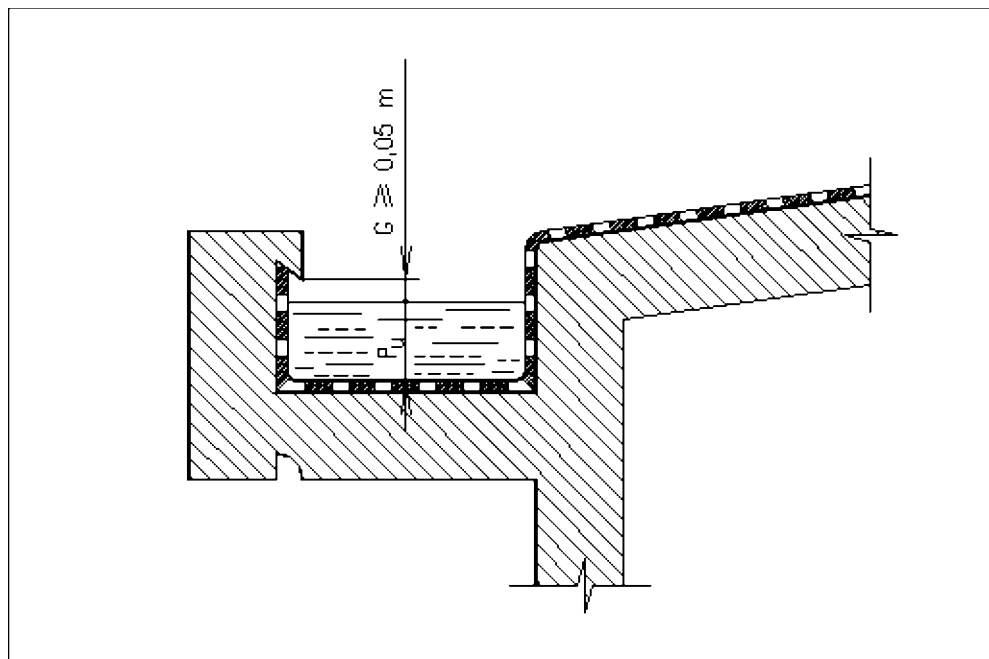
Chéneau encaissé avec revêtement d'étanchéité autoprotégé
